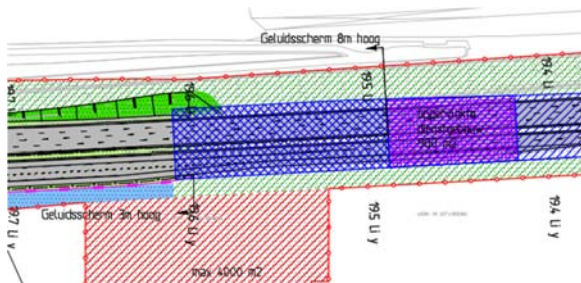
Situatie wTB Zuidelijke tunnelbuis ZO
